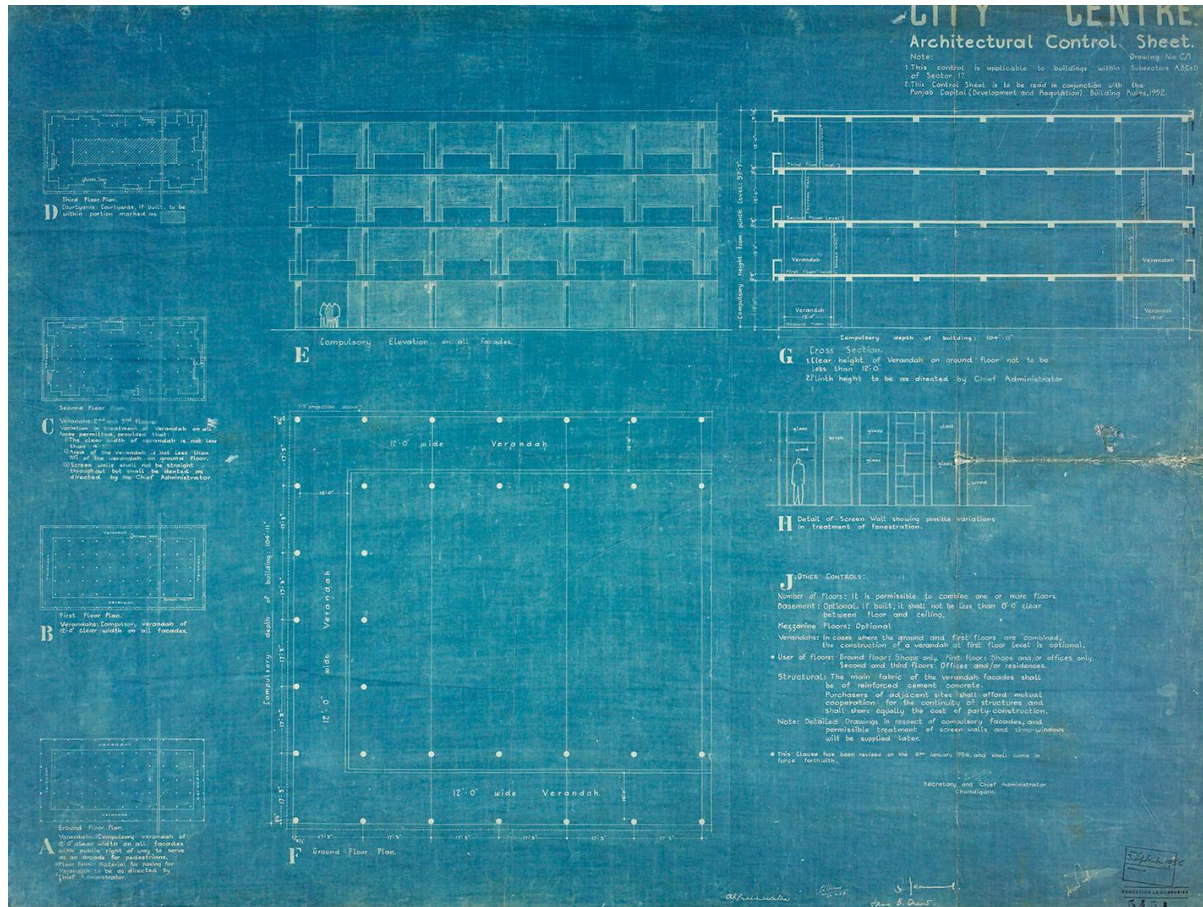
Feuille de contrôle architectural / Plan, élévation et coupe avec détails montrant niveaux, balcons, murs, façades, pans de verre, indications, cotes et nombreuses notes sur l'ensemble, en bas à droite, tampon de réception du 3-9-56, au verso à gauche, tampon atelier d'architecte et signature avec date 30-5-56 au crayon vert / P. Jeanneret, Varma, A.R.P. / 23-10-54 / Tirage héli / Papier tirage / 0.5 x 0.99 / 5.451 (©FLC-Prolitteris)
